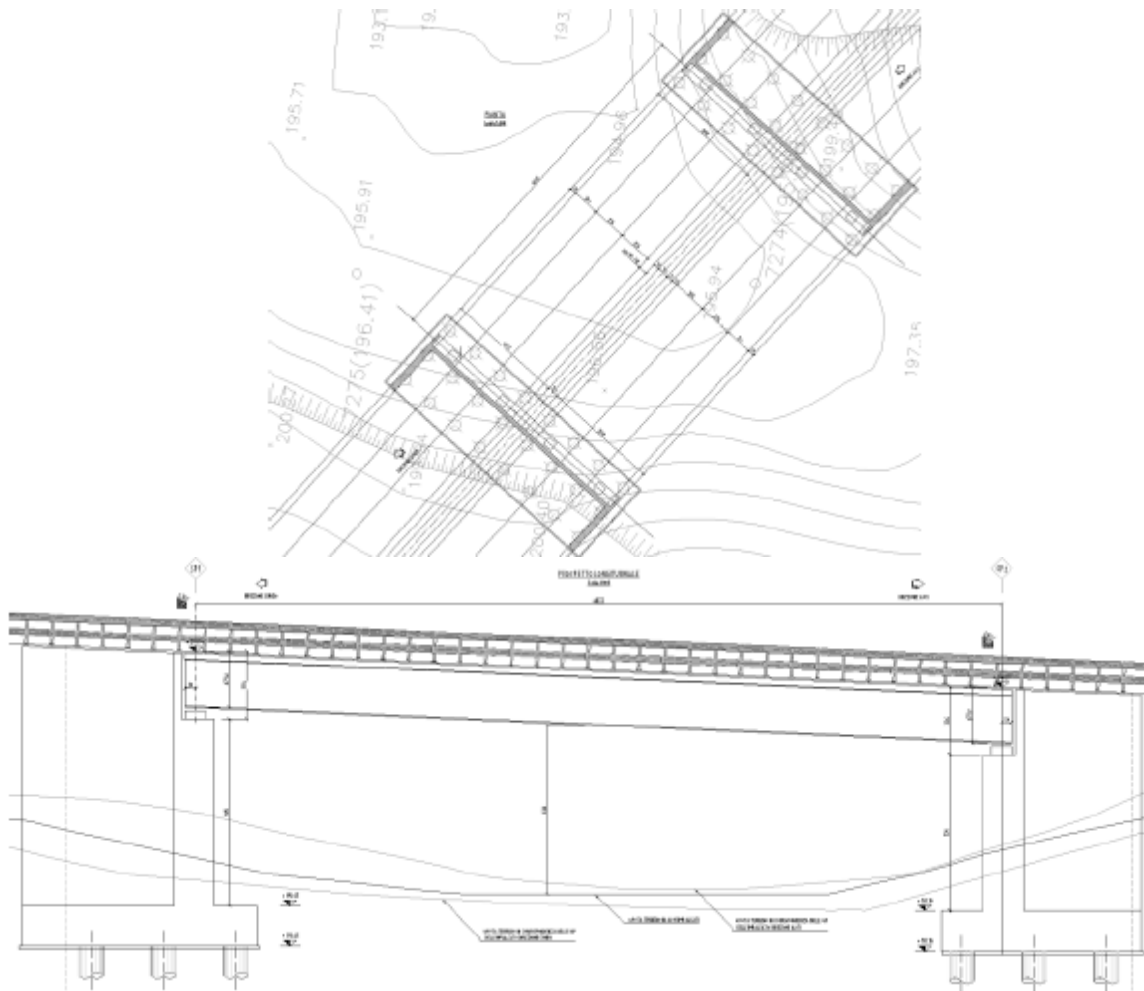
Ponte Opera 3: Planimetria e sezione longitudinale.
